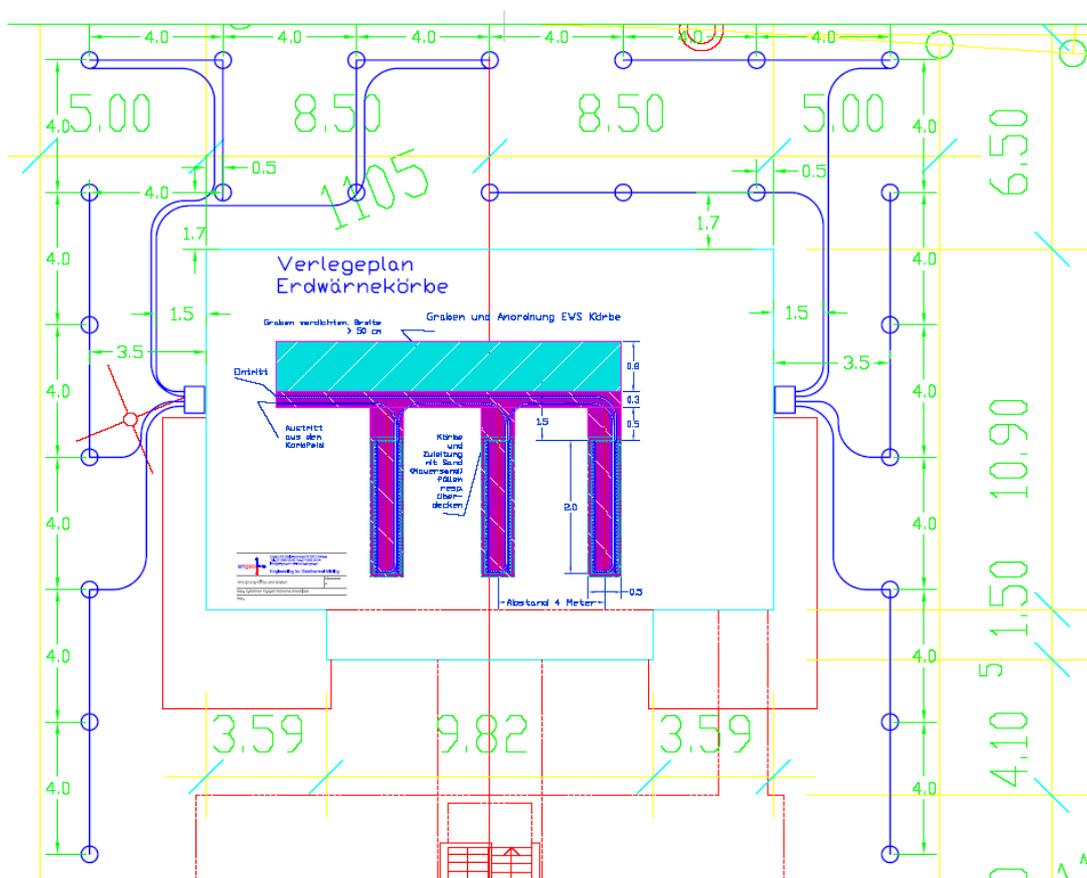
Schema der Erdwärmekörbanlage in Sulzbach
